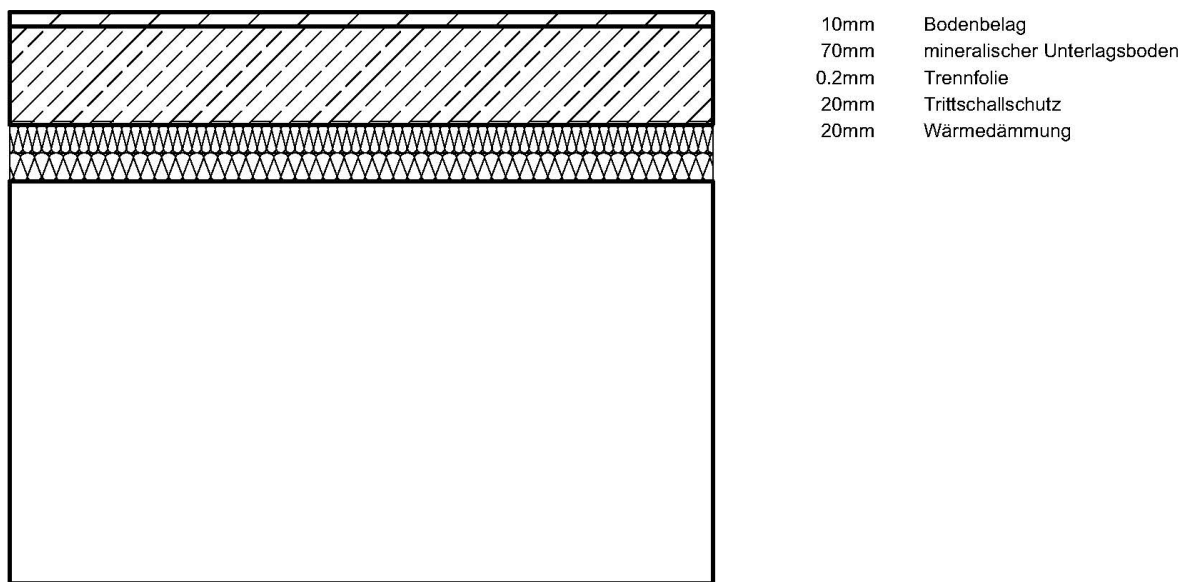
Gebräuchlicher Bodenaufbau bei Massiv- und Verbunddeckenkonstruktionen, bei Holzdecken in Kombination mit Unterdeckenaufbau
